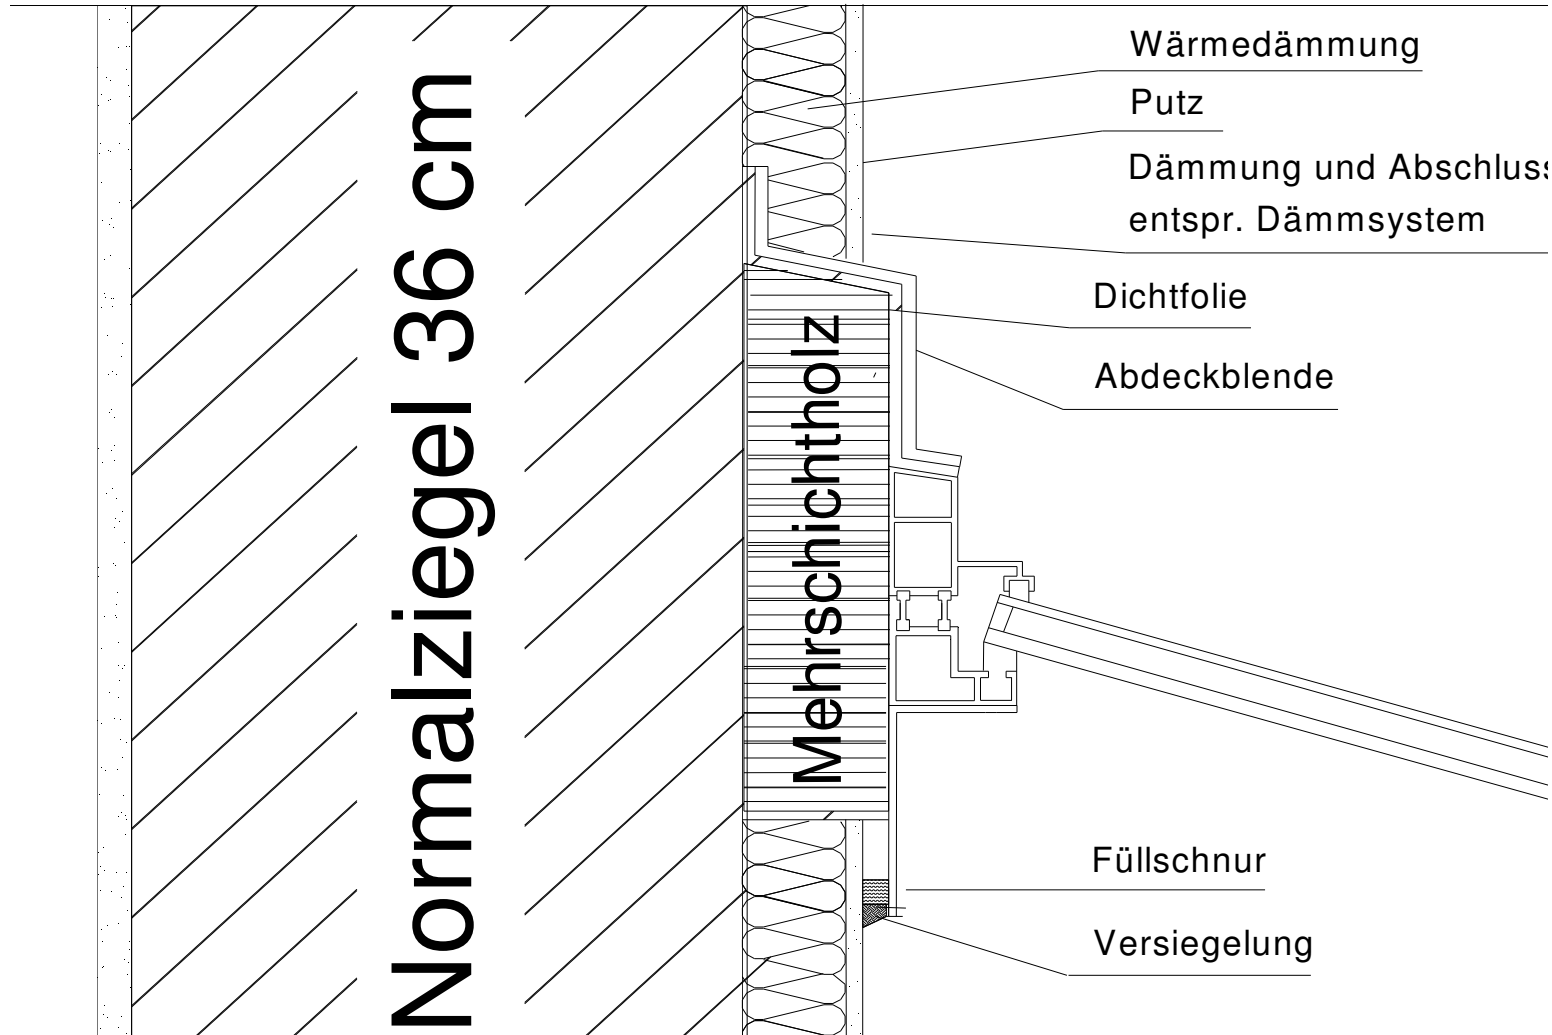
Horizontaler Wandanschluss, Mauerwerk mit Wärmedämm-Verbundsystem. Aluminium-Wintergarten
